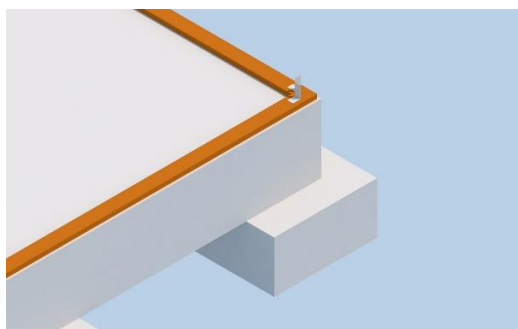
La colțuri și la capetele tălpilor de lemn, se vor monta și colțare metalice ce vor prinde elementele verticale din lemn.
